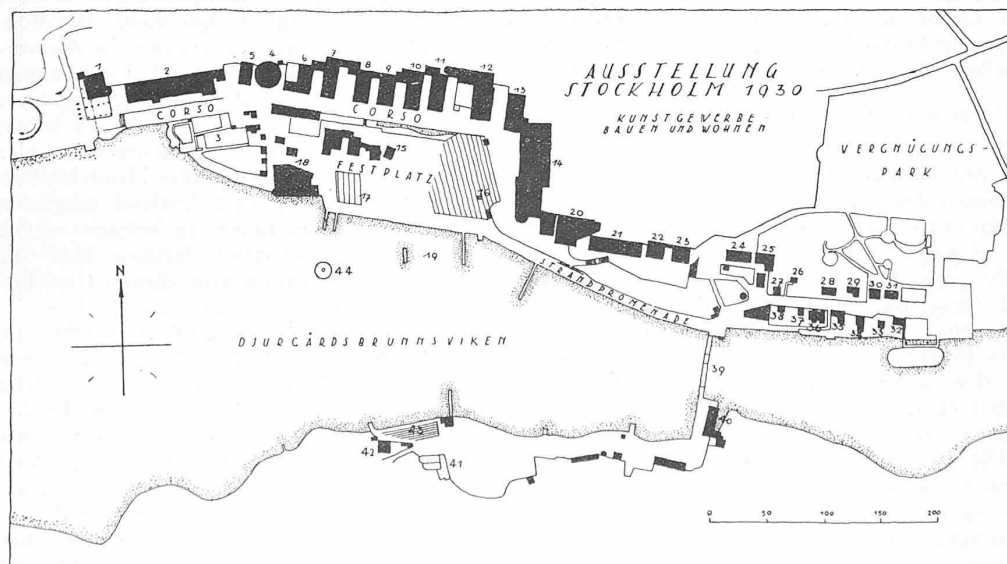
Lageplan der Ausstellung Stockholm 1930. — Masstab 1 : 6000.
